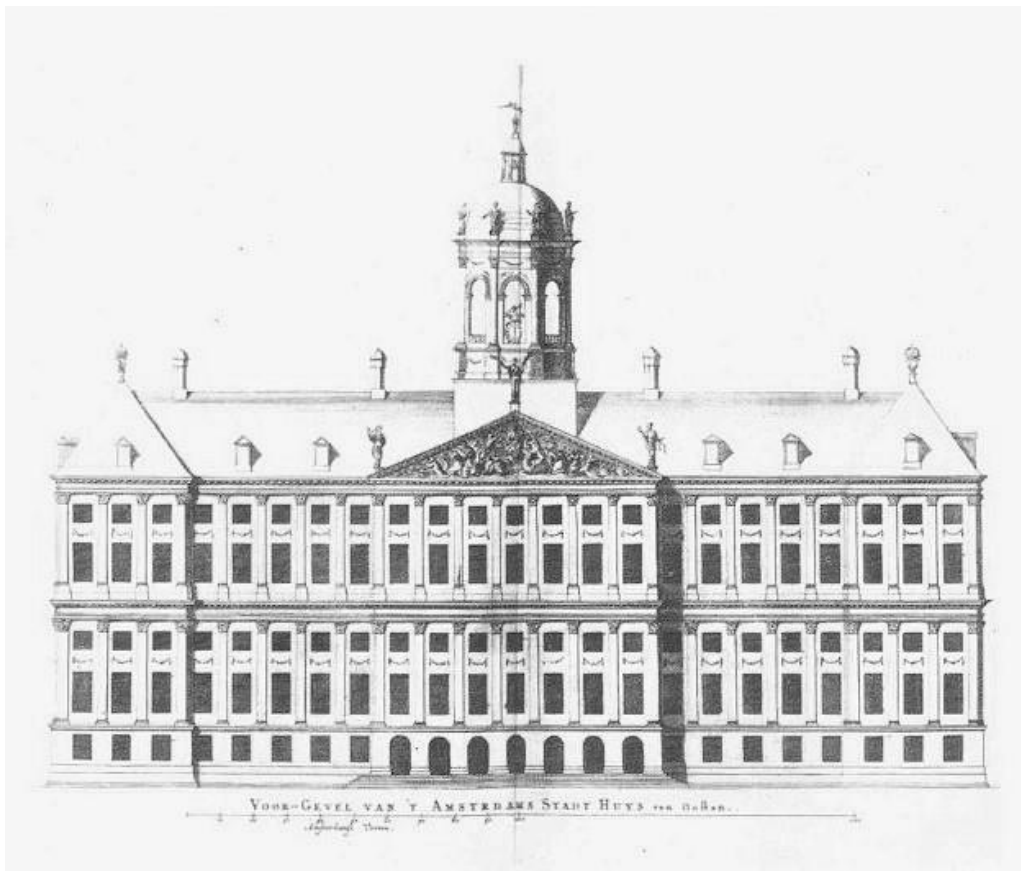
Jacob van Campen: Amsterdamer Rathaus, Hauptfassade, Amsterdam, 1648
